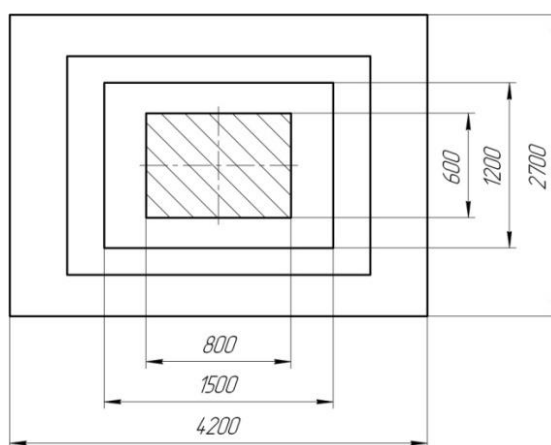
Фундамент под колонны серии КЭ-01-49
